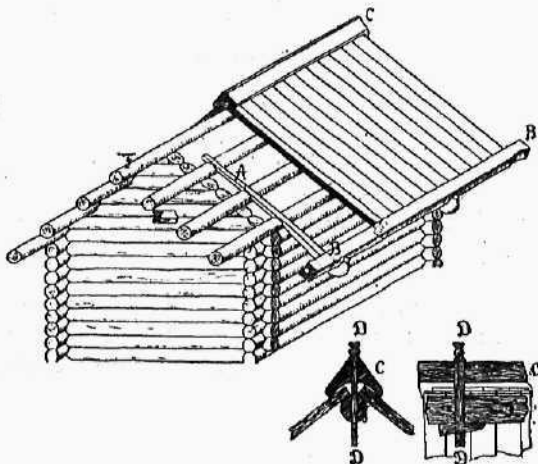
Схема конструкции кровли: А—„курицы“; В—„поток“; С—„шблом“; D—D—„шарики“; E—тес кровли; F—„конь“.
